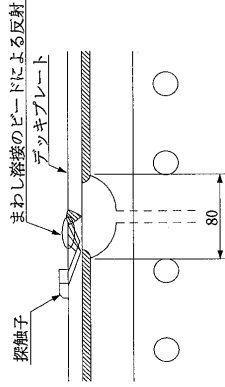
デッキプレートの完全溶込み開先溶接による溶接継手と交差する閉断面リブ、横リブ、横桁、縦桁等の溶接部の超音波探傷による検査の例
